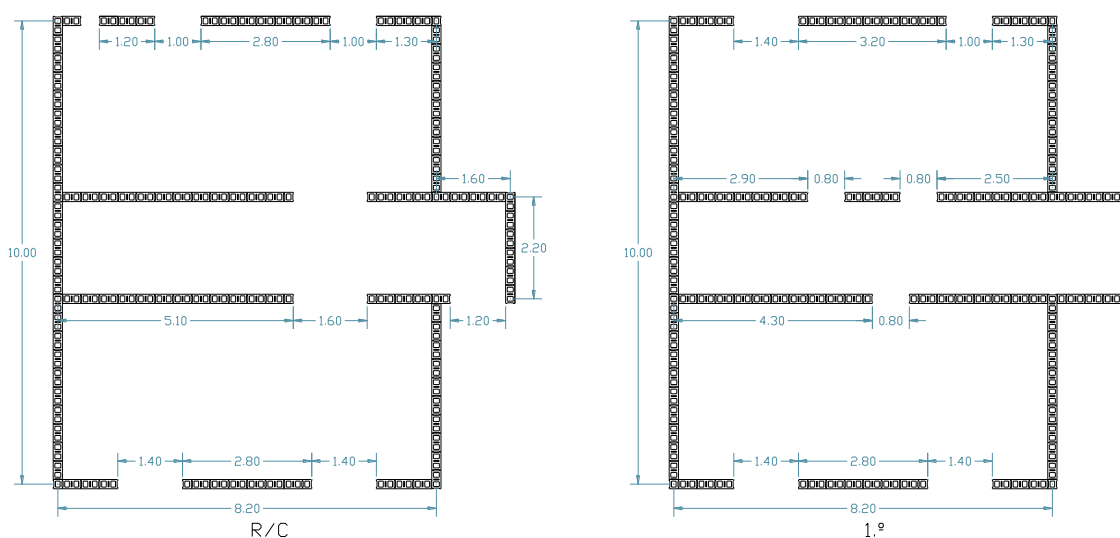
Planta estrutural adotada para a moradia na Mealhada
